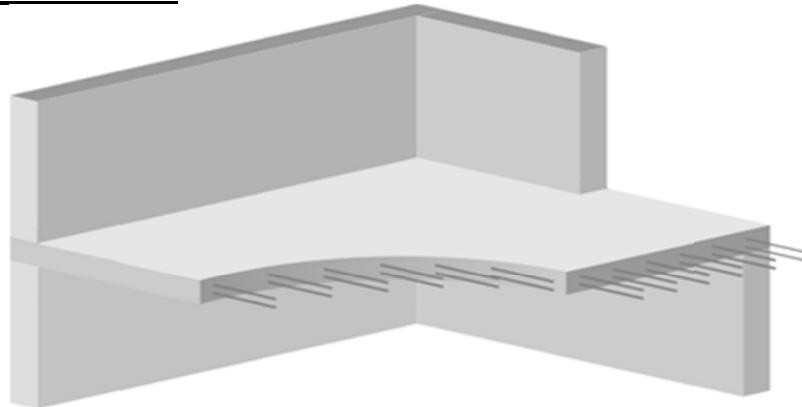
Constituants de la dalle du RDC (dalle pleine)
